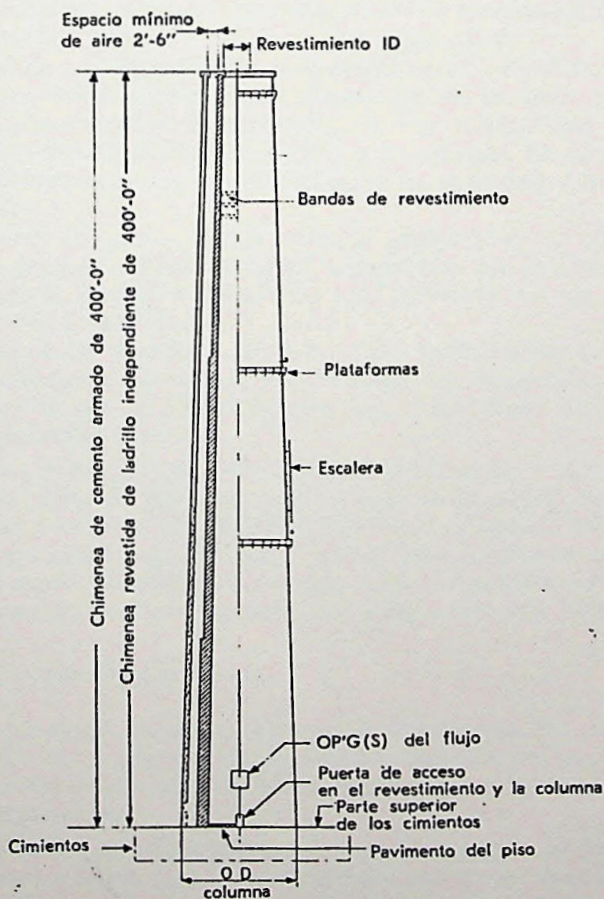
Una chimenea moderna alta es típico que tenga una columna de cemento armado y —excepto en el caso de las chimeneas muy altas— una columna independiente de ladrillo. (Custodis Construction Company.)
